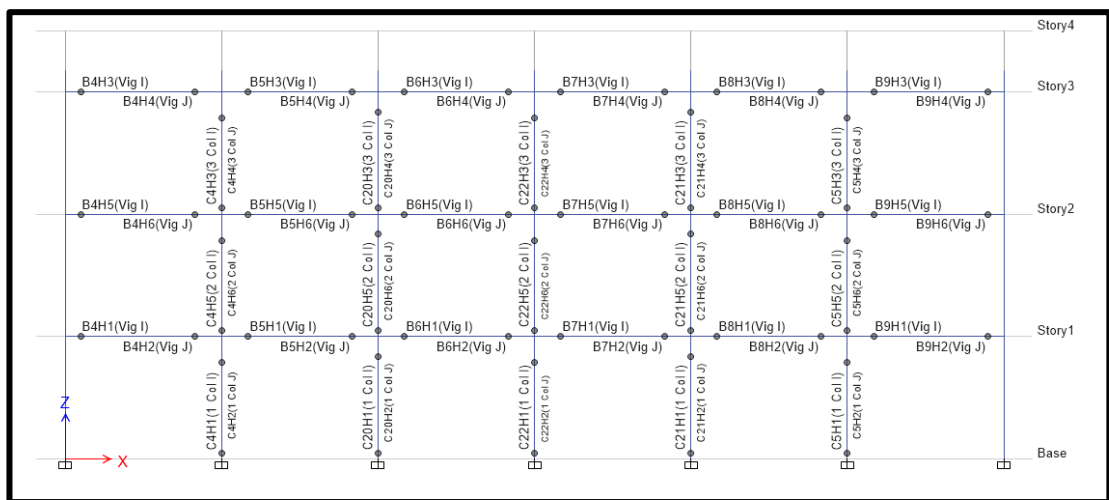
Vista de la Elevación “2” con Rotulas Plásticas asignadas en Elementos Estructurales.
